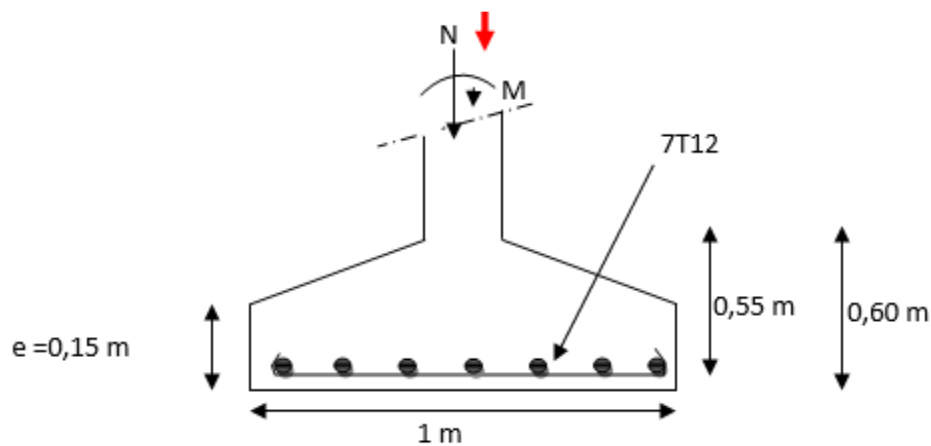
1 : Ferrailage de la semelle intermédiaire
